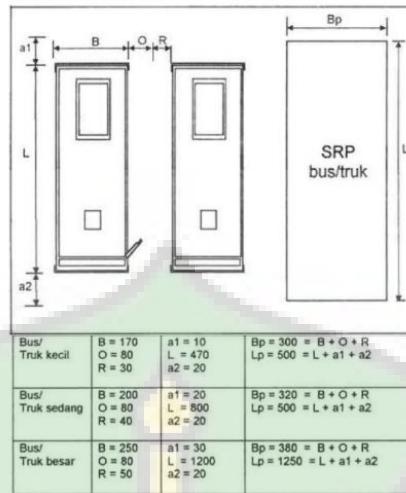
Penentuan Satuan Ruang Parkir
